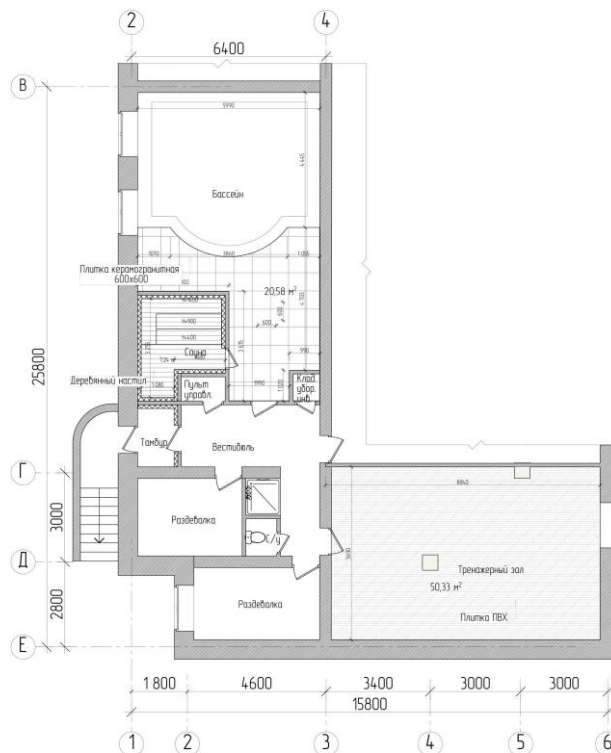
Фрагмент плана пола цокольного этажа (баня, бассейн, тренажёрный зал)
